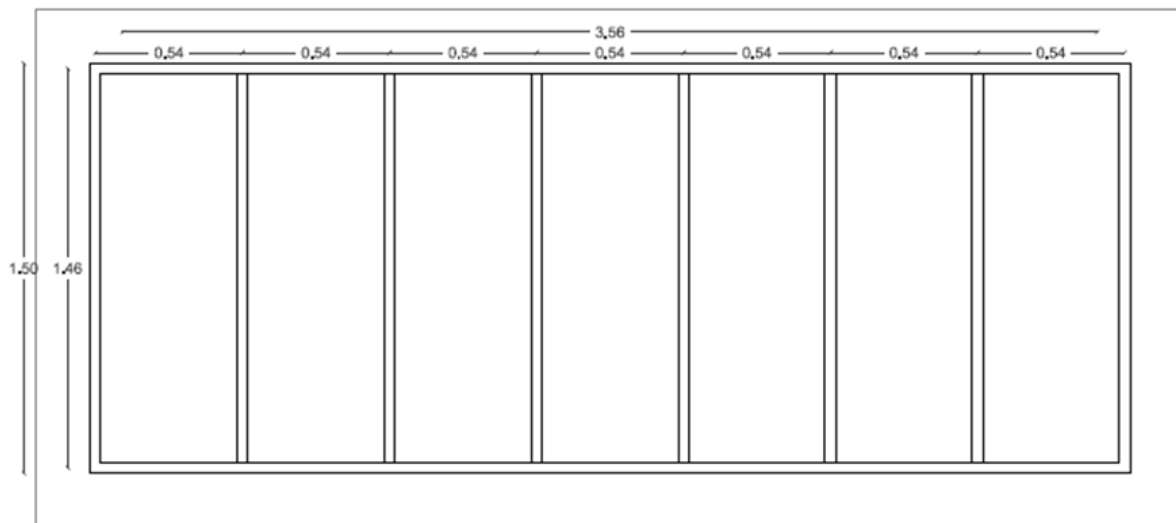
Dispositivo 2 (2 unidades). Balda de cristal + base de madera. Planta
